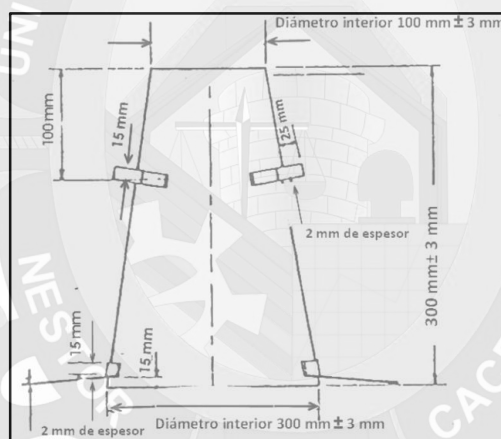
Dimensiones de molde para el ensayo de asentamiento
